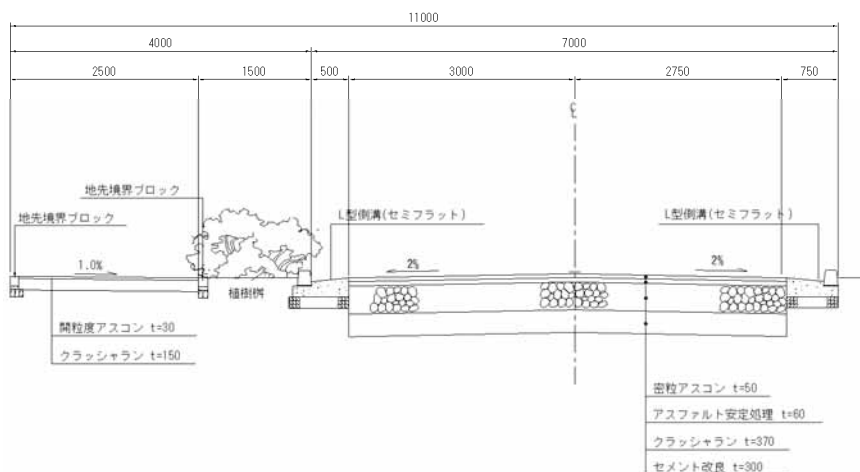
(3) 道路標準断面図（外周準幹線道路）
